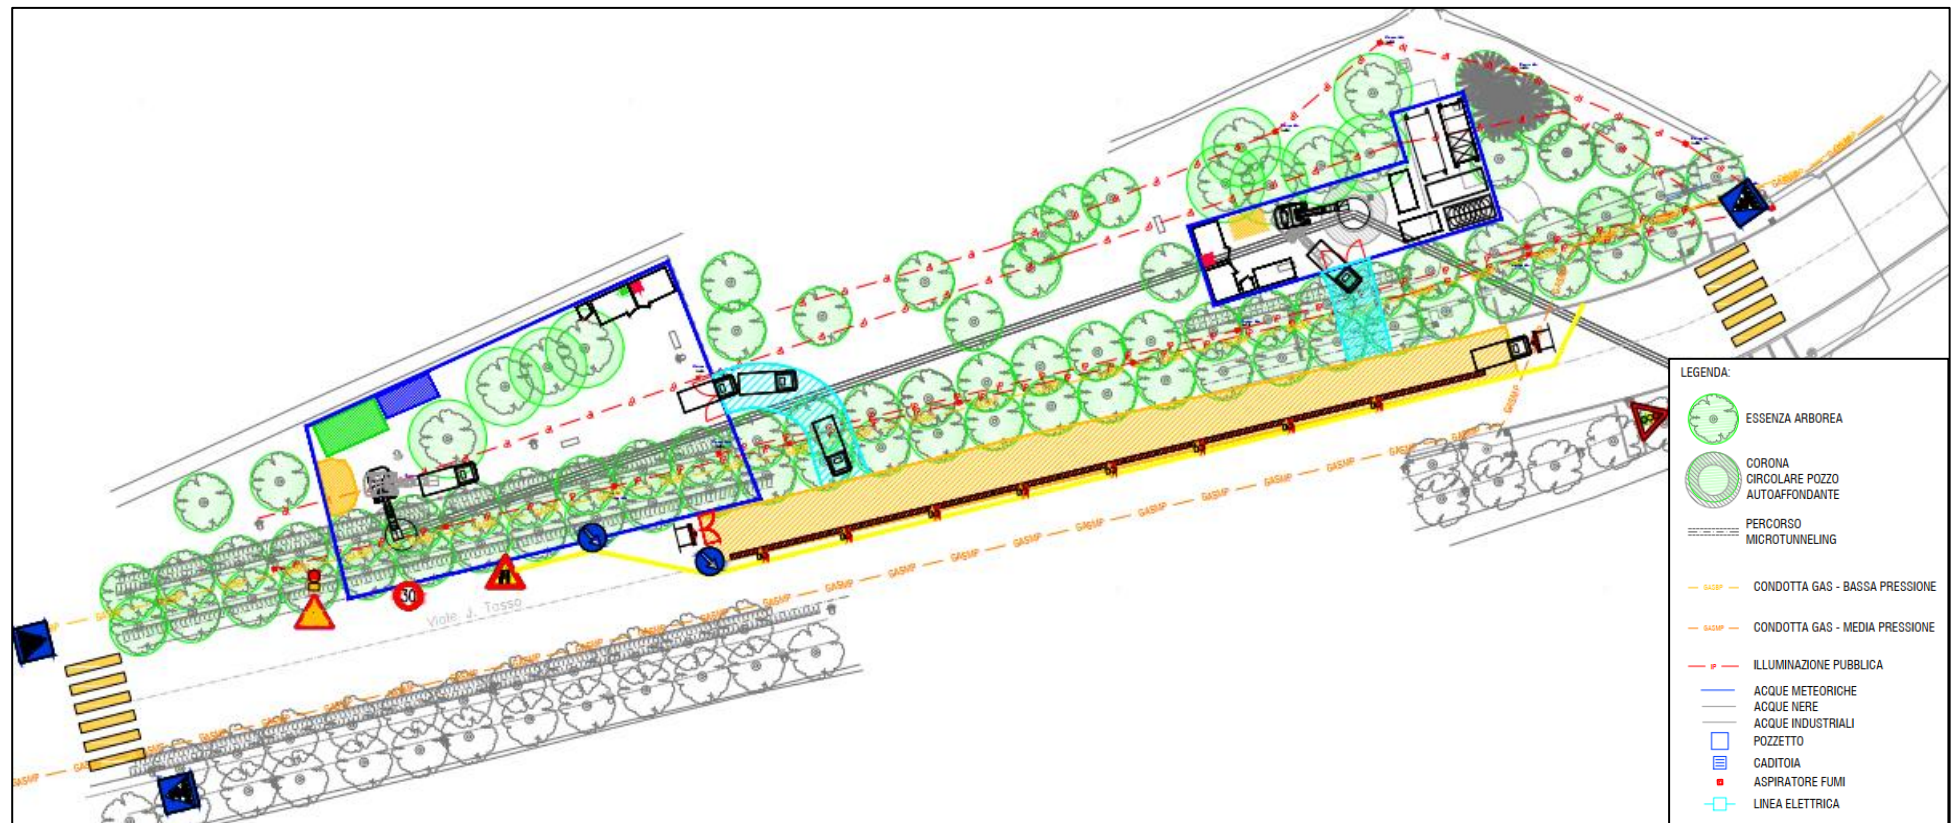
Inquadramento planimetrico aree di cantiere Pozzi 3 e 3a
